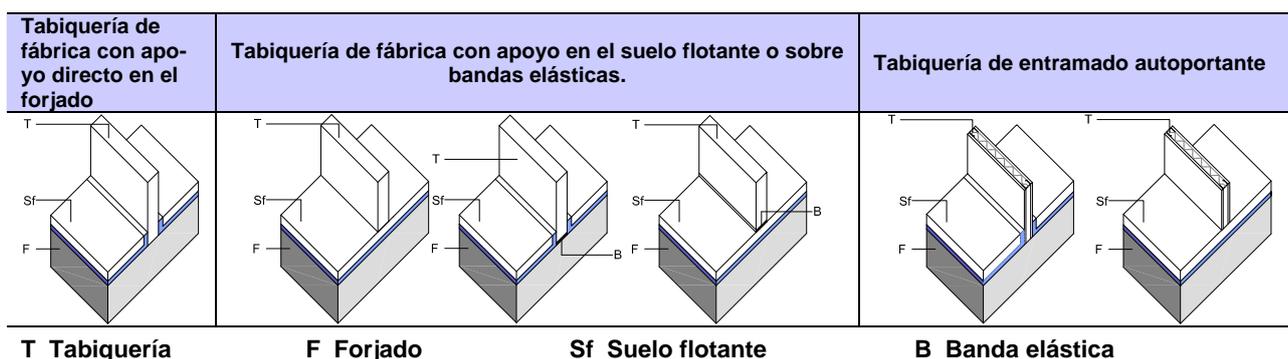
Tipos de tabiquería recogidos en el DB HR.
